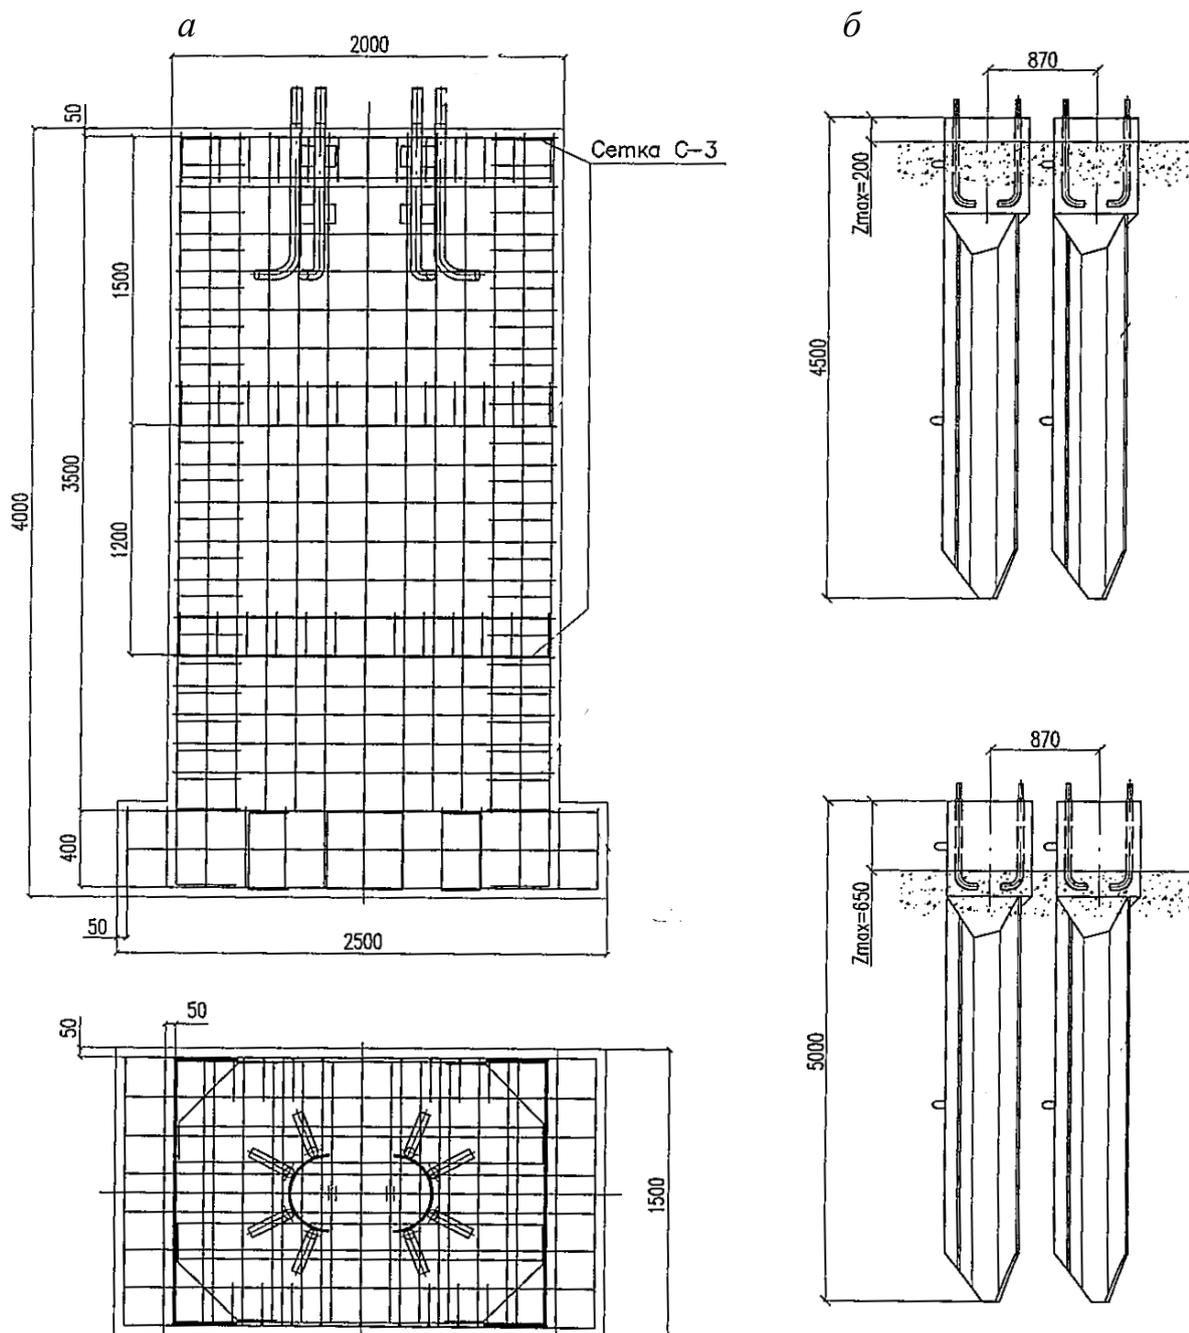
Фундамент монолитный – а; и ТСП– б для опоры МТА-9-40
